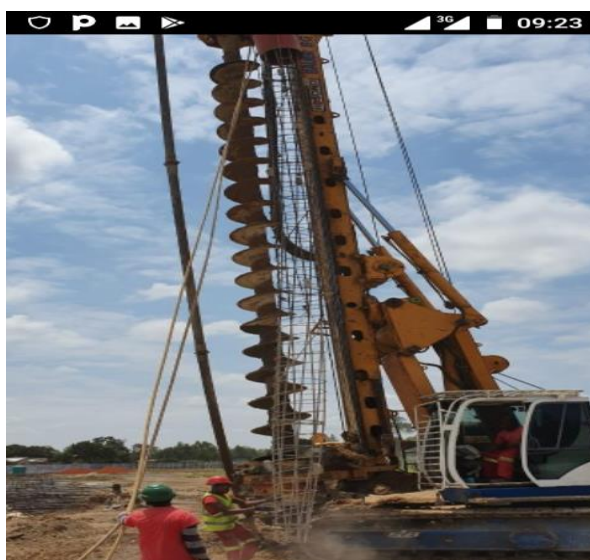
Elevação da armadura recorrendo ao equipamento de furação (fonte: Autor)
